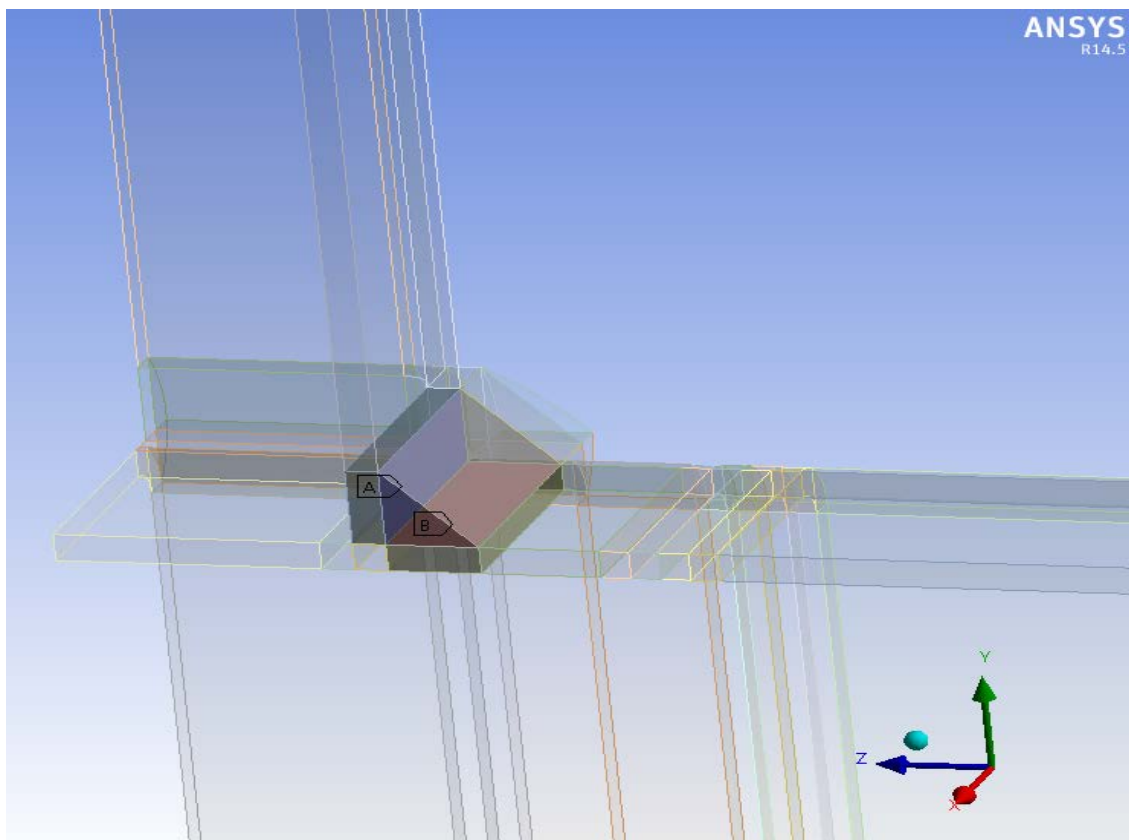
Modelo 3. Contactos: Soldadura de la cara interior de la unión en T sobre montante y cordón
